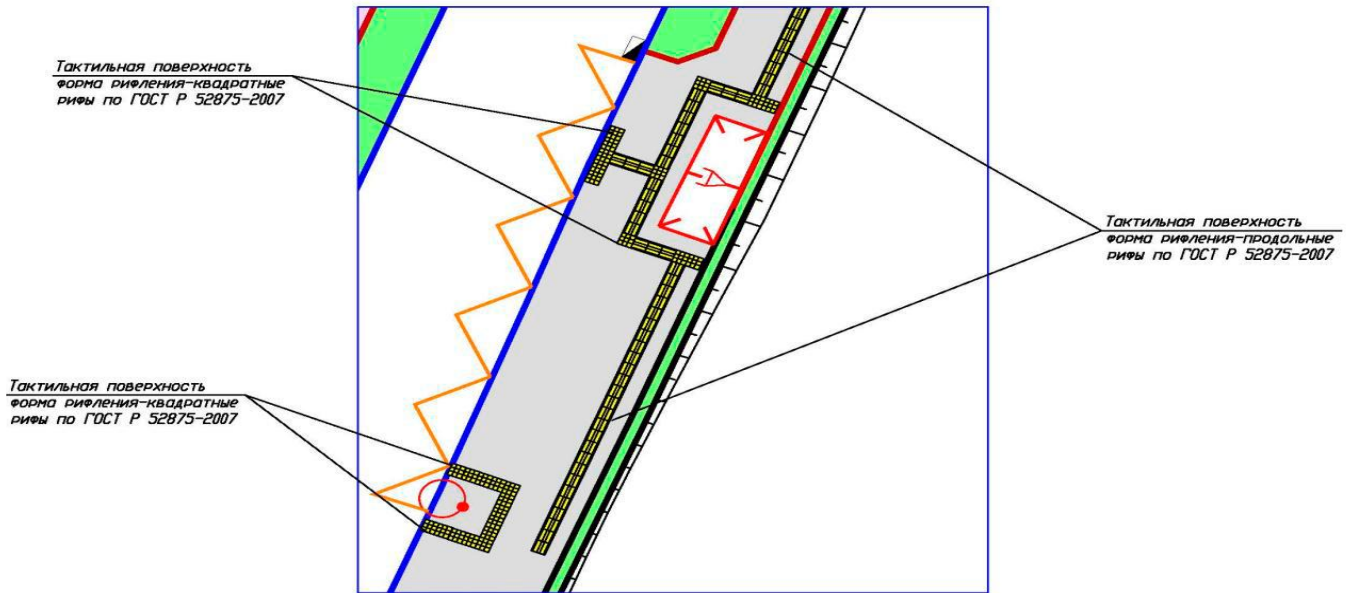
Типовая схема укладки тактильных плит на посадочных площадных остановках общественного транспорта
